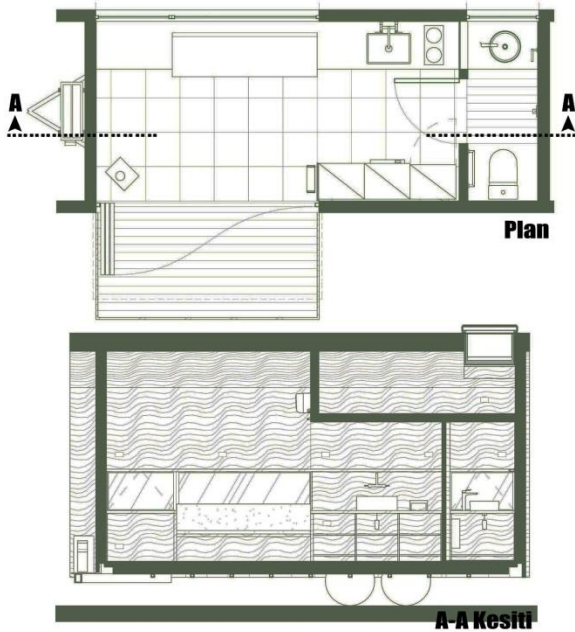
Sol Duc Cabin Plan ve Kesit (URL 1).
